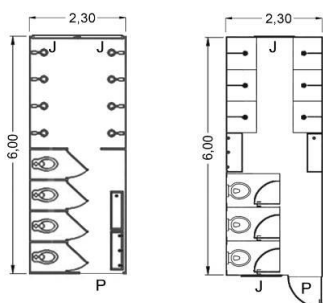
Planta com chuveiros e sanitários. Fonte: www.delta.com.br, www.lafaete.com.br.
